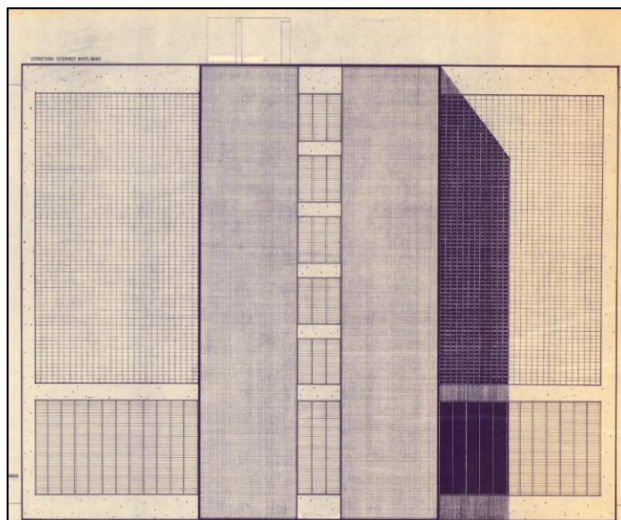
Elevación fachada lateral del Edificio del ala norte de la Facultad de Medicina (Sector Norte) (Plano de la edificación, 1965)
